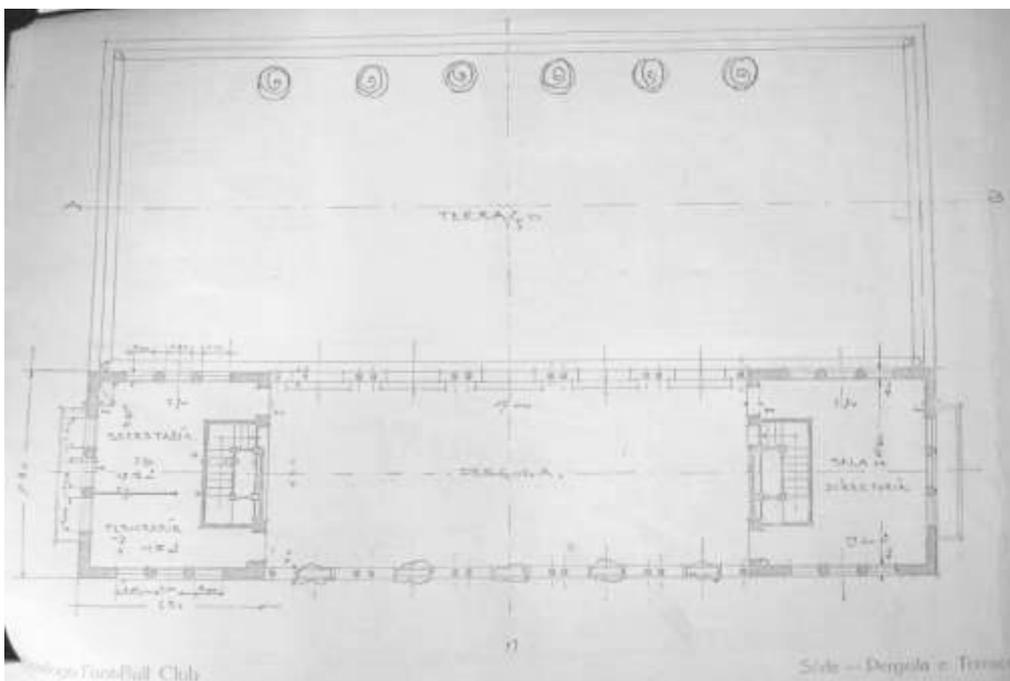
Projeto para Sede Botafogo Futebol de Regatas - Planta Baixa Pérgula e Terraço.
